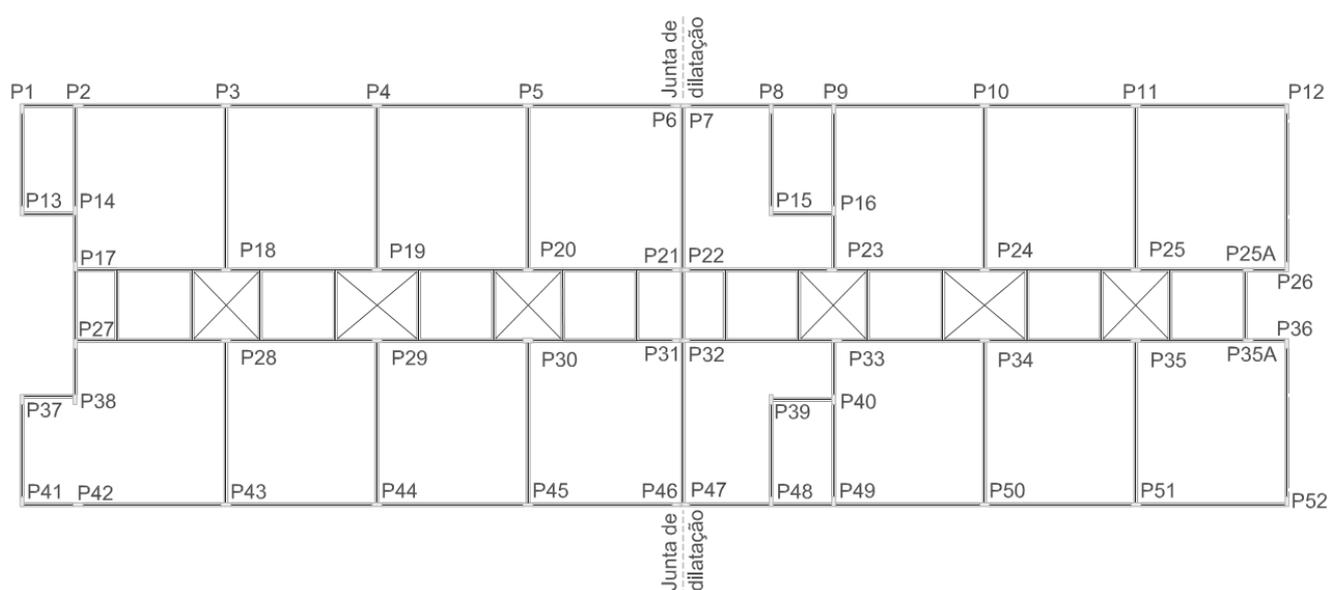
Planta de fôrmas do pavimento Fundações do prédio.
